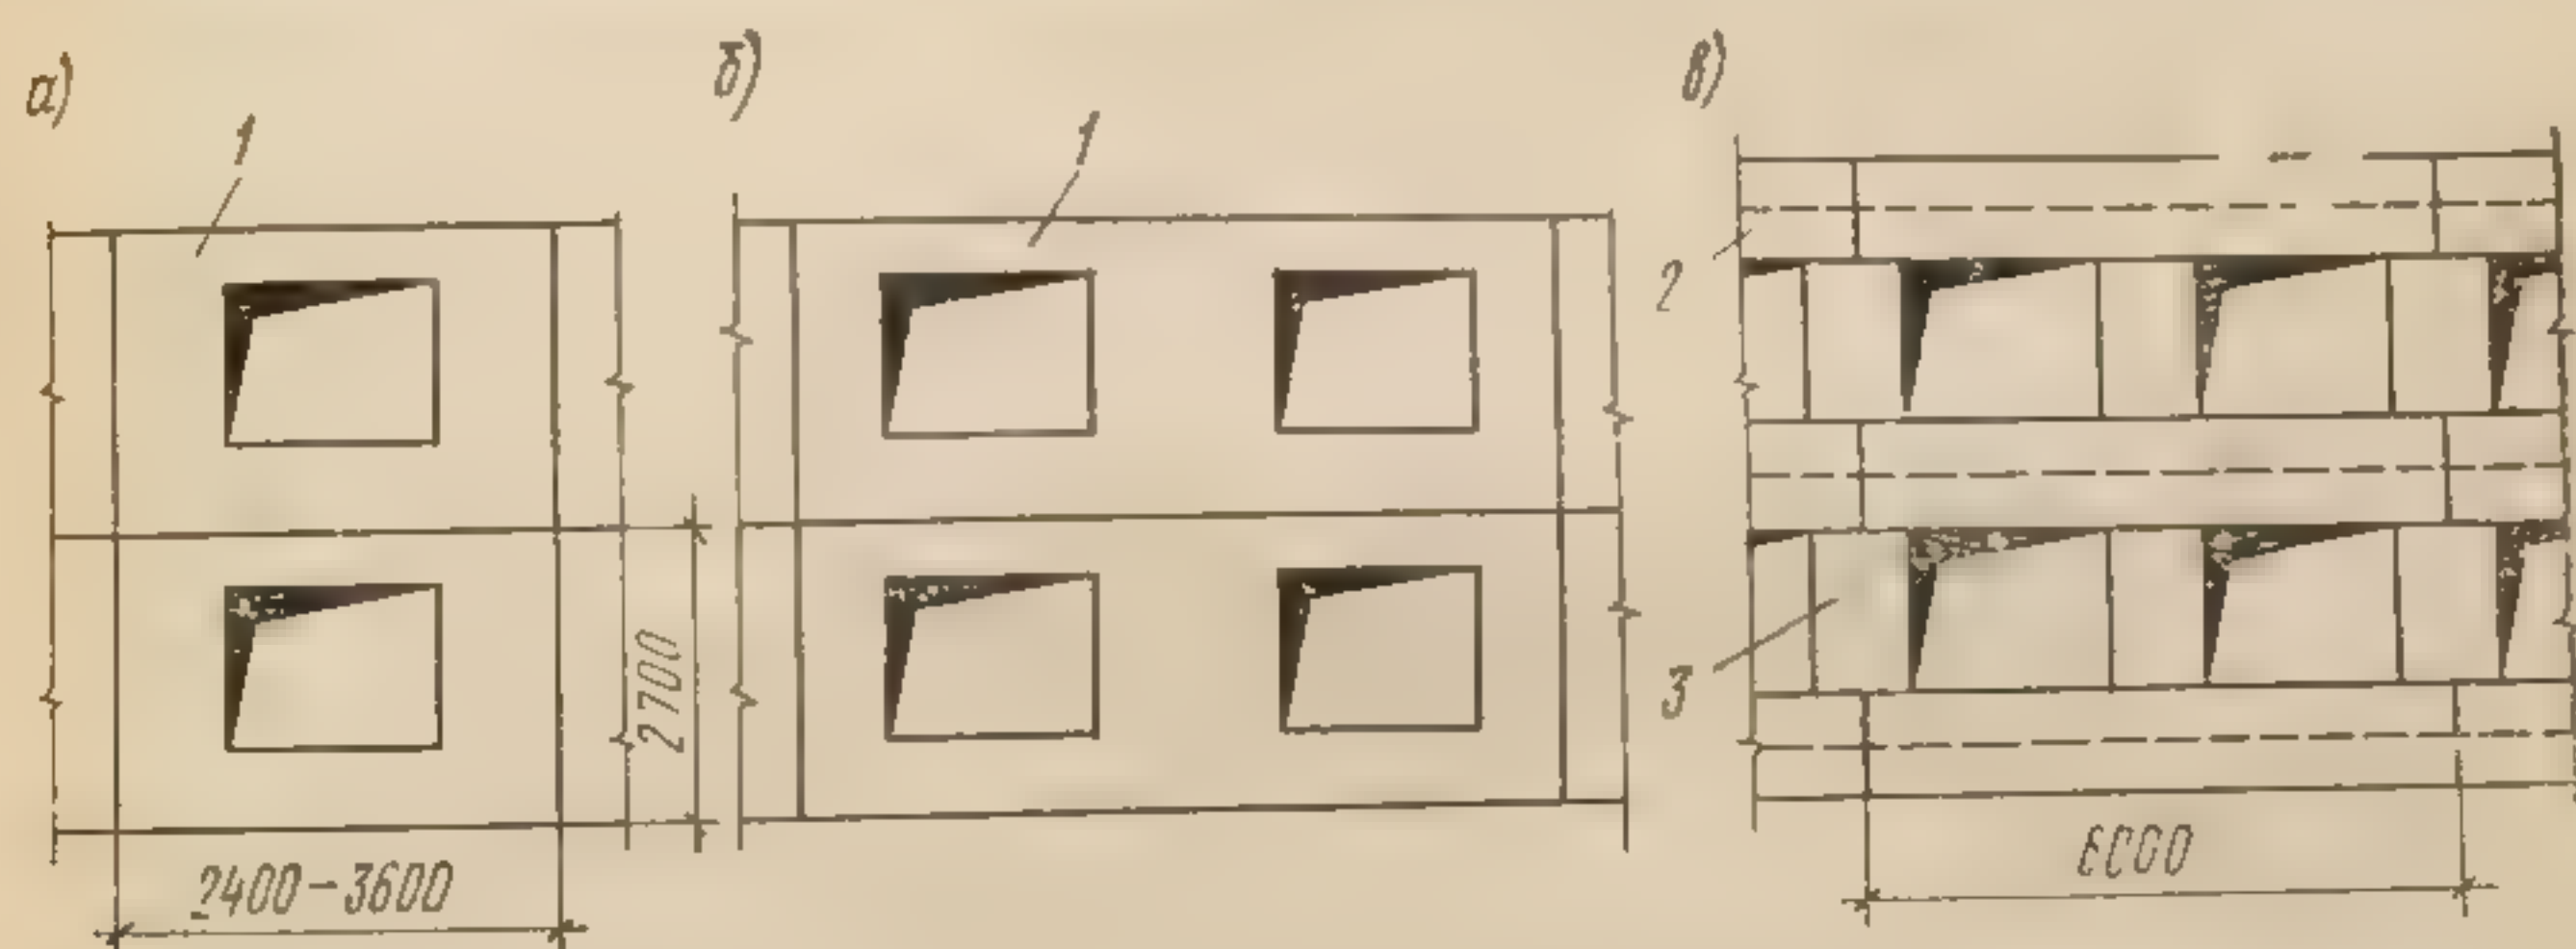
Схемы разрезки наружных стен жилого дома на панели:
